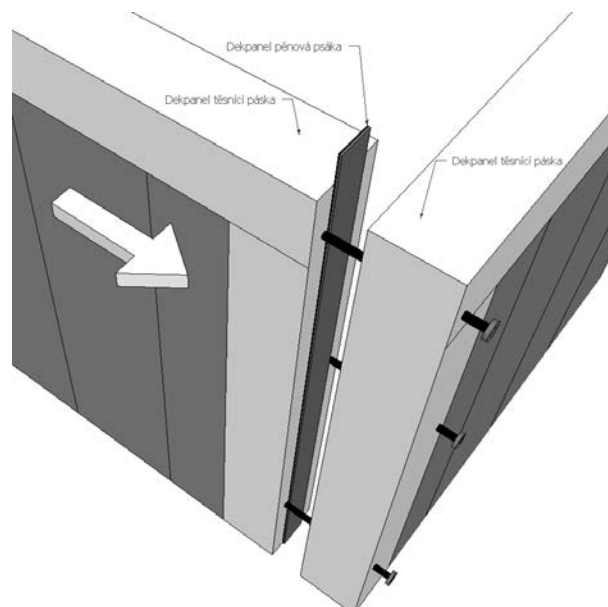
Vruty šroubované horizontálně pod úhlem 45° - varianta b)
